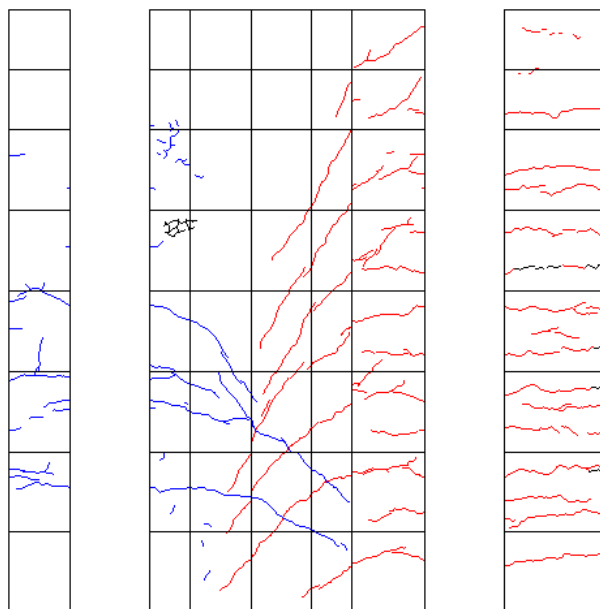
R=-1/200②ひび割れ図
